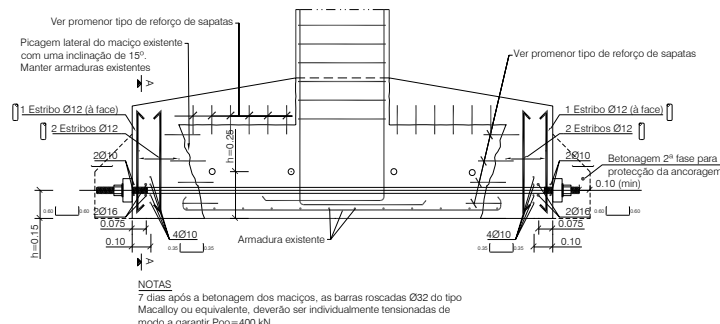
Pormenor tipo do reforço das sapatas existentes – corte.
